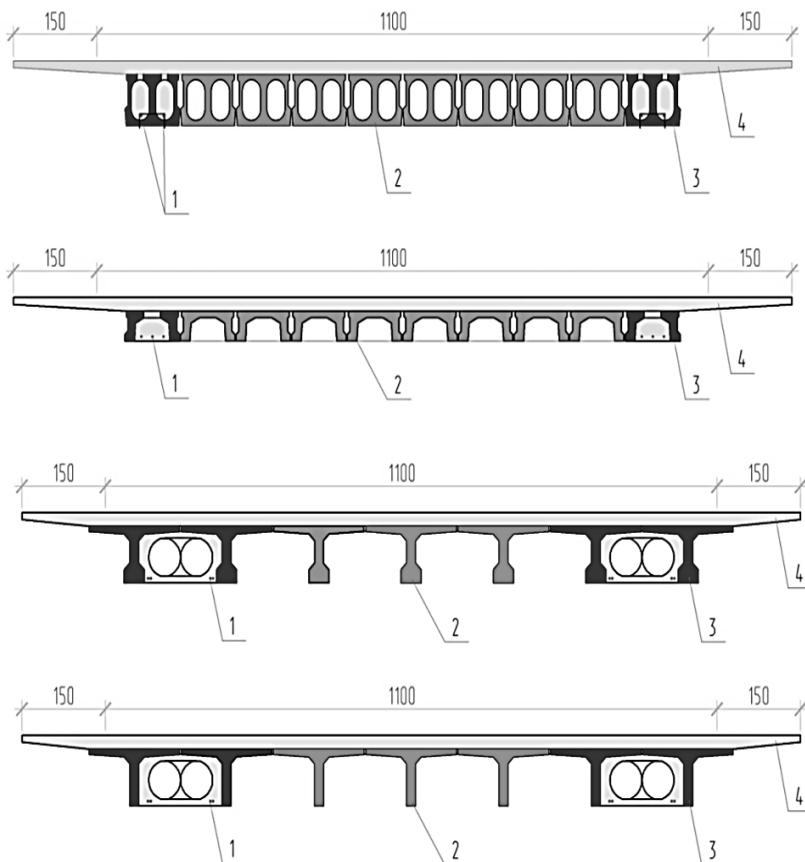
Схемы уширения и усиления балочных пролетных строений монолитной накладной плитой с устройством крайних сборно-монолитных балок с напрягаемой арматурой
